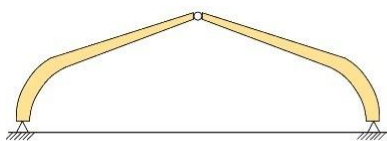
Construction par portiques préfabriqués (source : Leçon 2 : Systèmes de construction en préfabrication/pdf)
